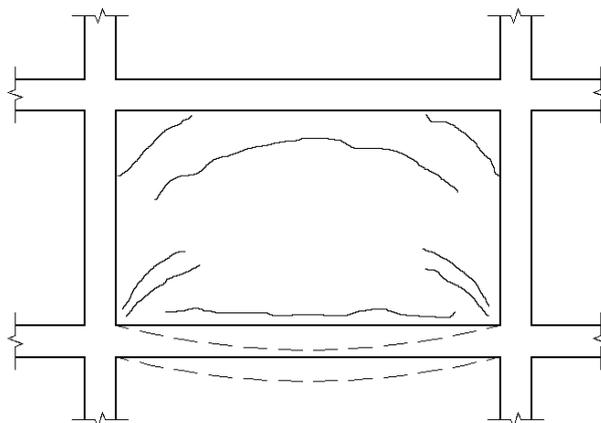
Fissuração causada pela deformação da viga inferior (Fonte: THOMAZ, 1989)
